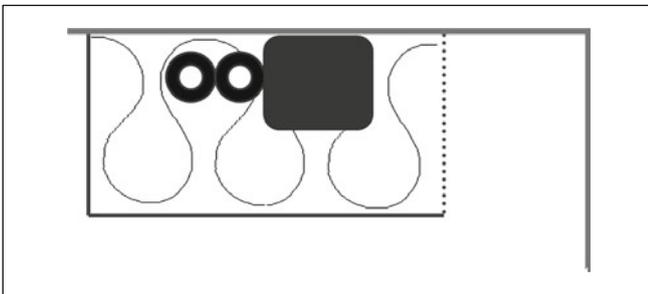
Der Kanten-Absorber als multifunktionelles Bauelement, in dessen zumindest teilweise mit Mineralwolle gefülltem Hohlraum alle möglichen Installationen untergebracht und geführt werden können.
